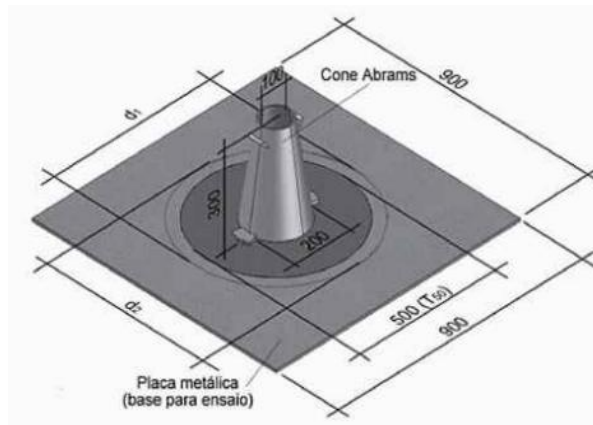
Ensaio de espalhamento (Métodos de dosagem de concreto autoadensável, 2009)
